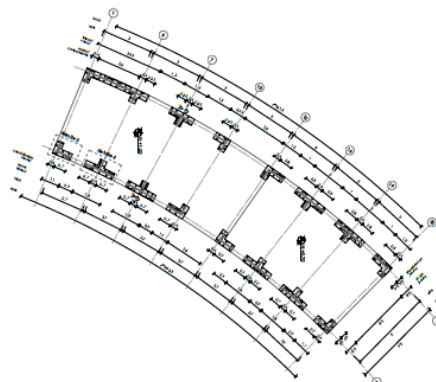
Planta estructural del bloque de dormitorios Fuente: Cristian Campaña, 2018
